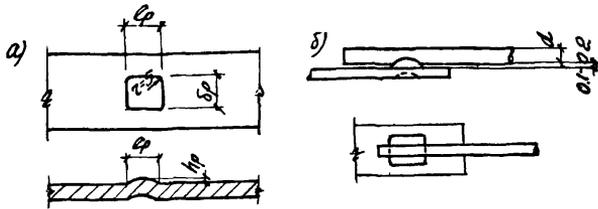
Соединение анкеров с пластиной внахлестку рельефно-точечной контактной сваркой
